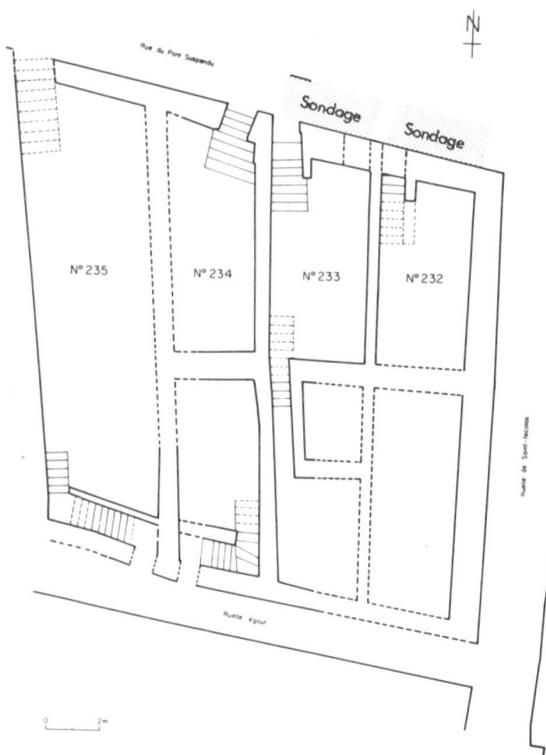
Rue du Pont-Suspendu 74–75. Reconstitution du plan des bâtiments médiévaux.
